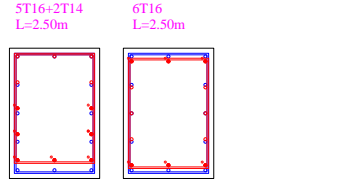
DETAIL DE CHANGEMENT C-C DU SECTION : 40X50 à 40x45 POTEAUX DE D'ANGLE
